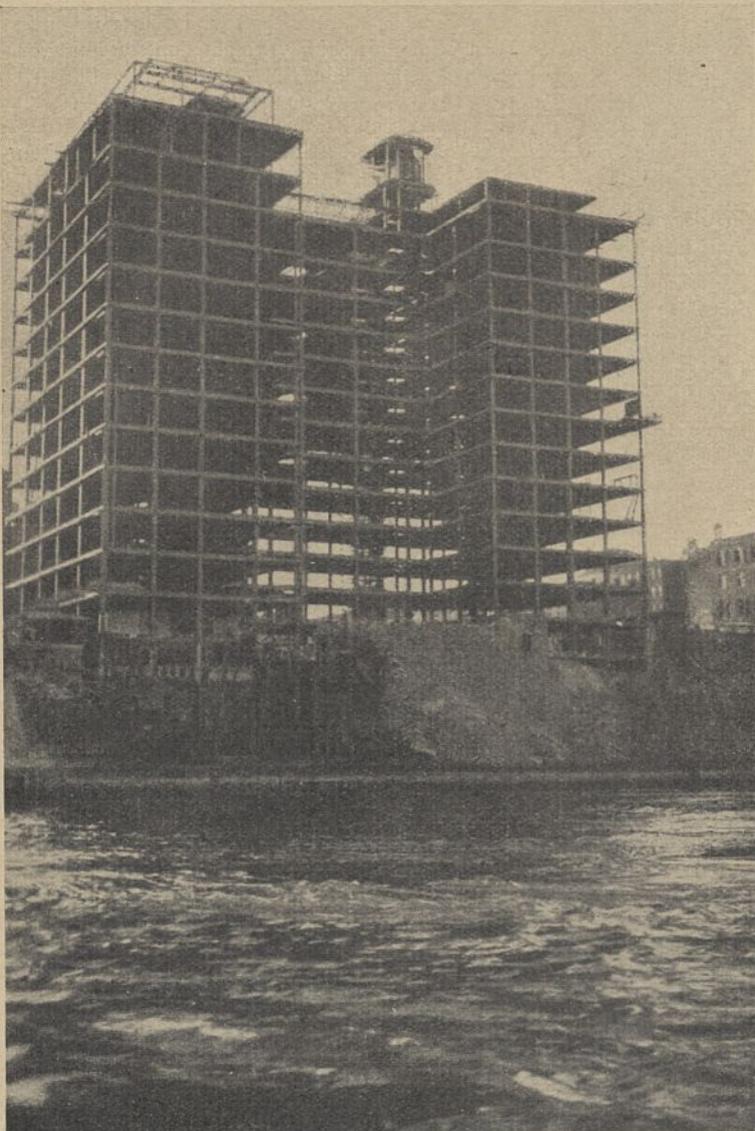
New York, Rohbau eines Hochhauses am East River. Eisenkäfigkonstruktion.
